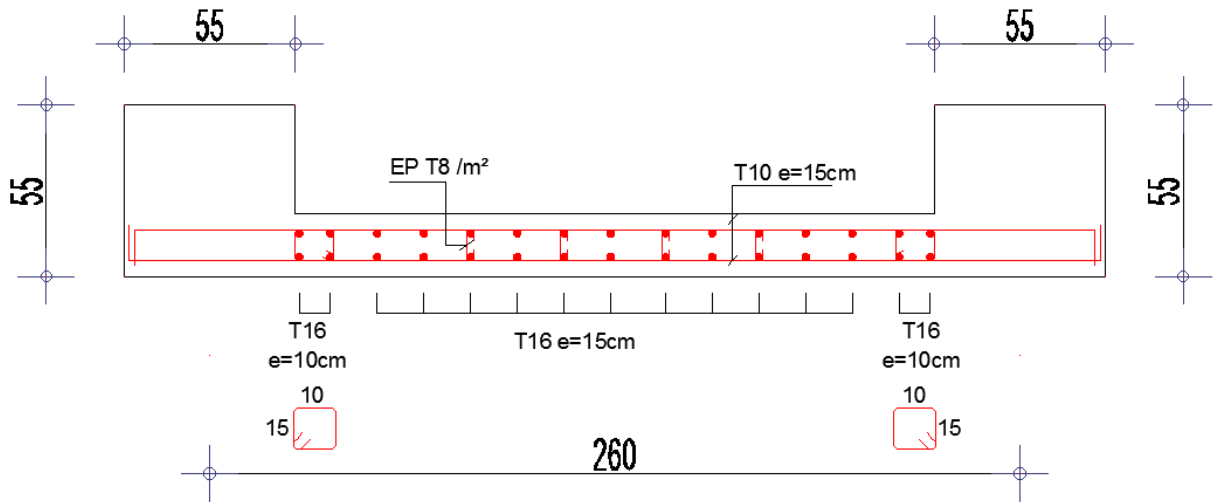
Schéma exemple de ferrailages voiles VX1/VX2/VY3 Zone I
